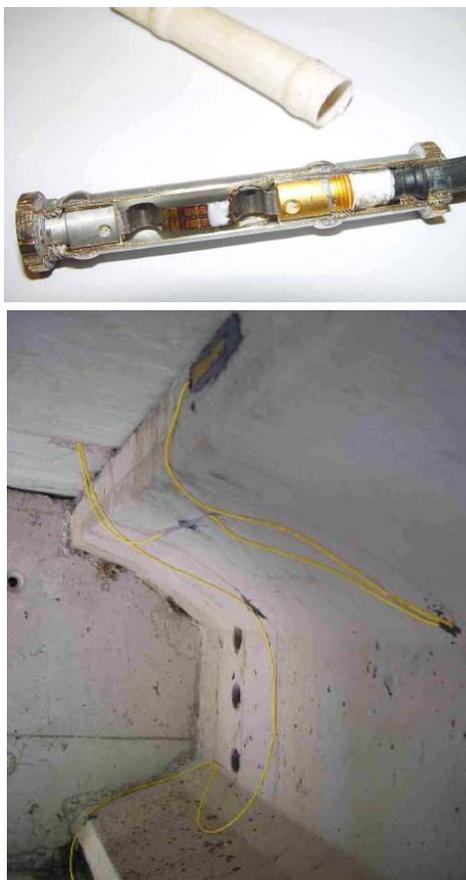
a) Extensómetro para medir deformações no betão; b) colagem de extensómetros em viga de betão.
